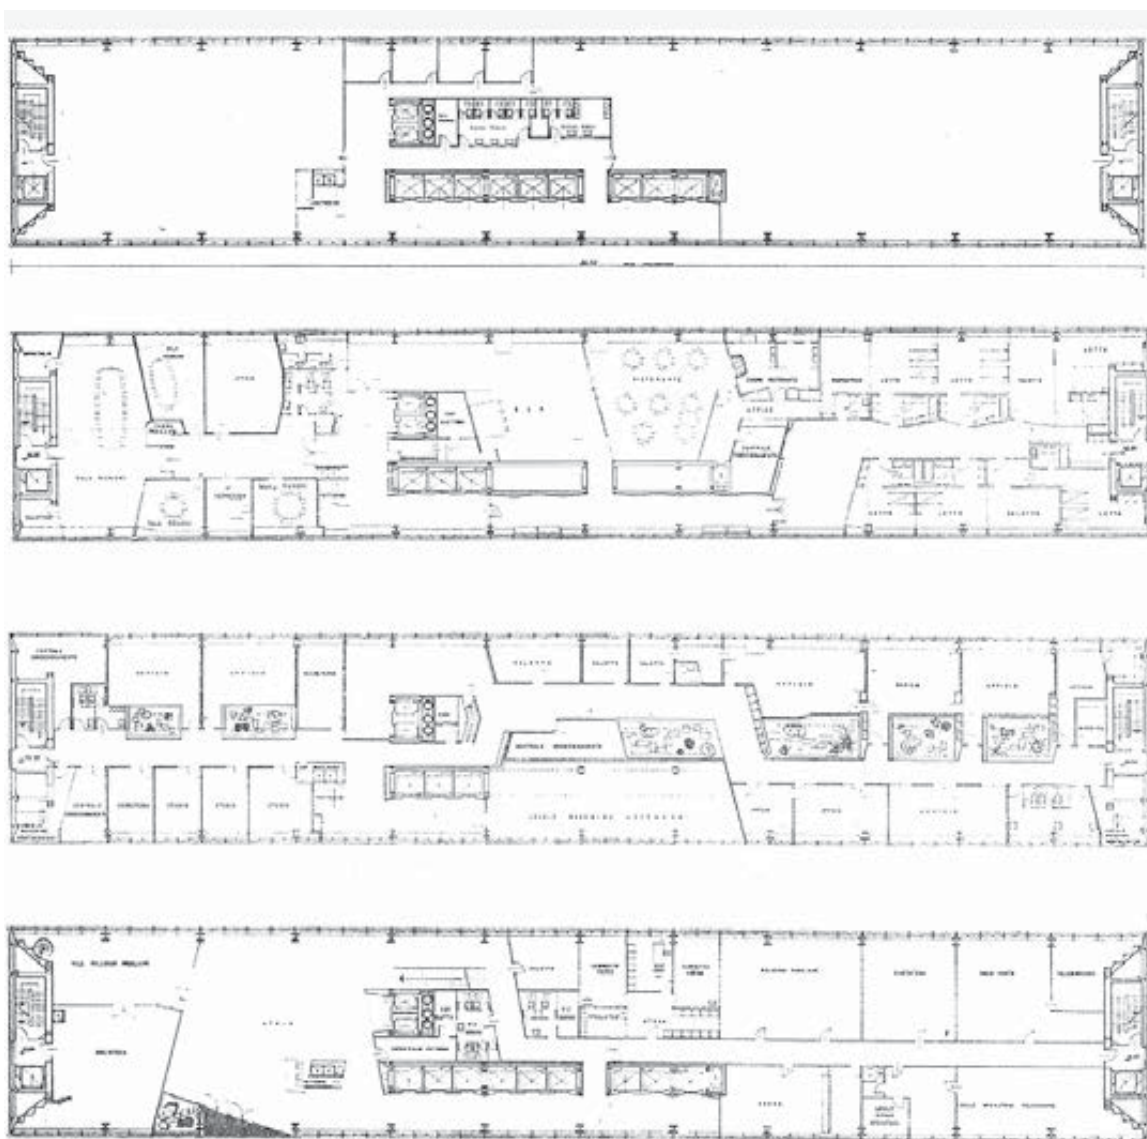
Dall'alto, pianta del piano terreno, del piano primo, del piano tipo, dei piani 19° e 20° (da Edilizia Moderna, n. 79, 1963)
